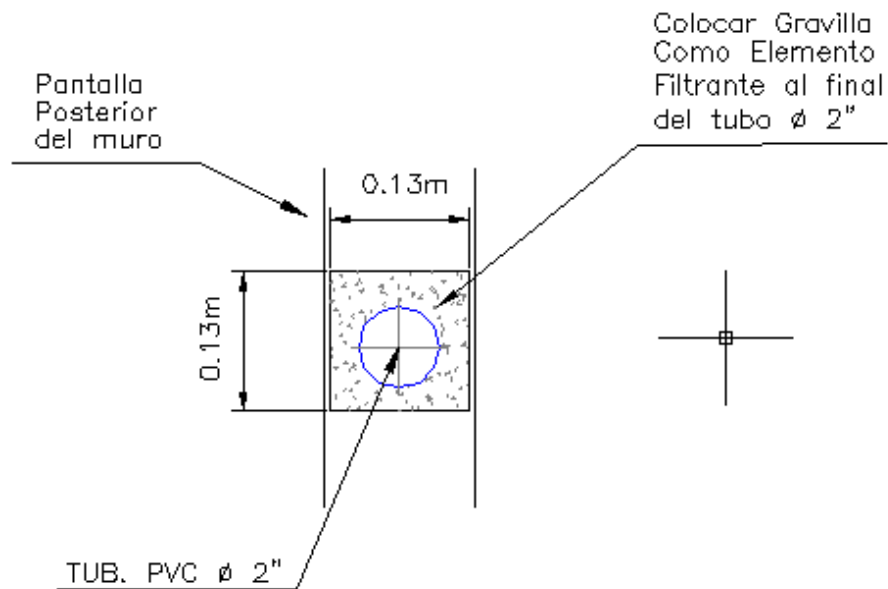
Detalle de abertura para el pase de la tubería de PVC 2"
